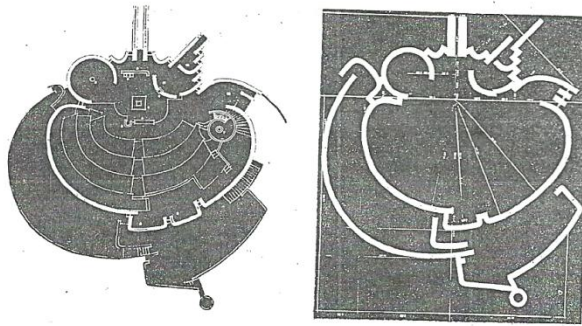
Pier Ludovico Rupè: Iglesia en Arezzo. Planta.
